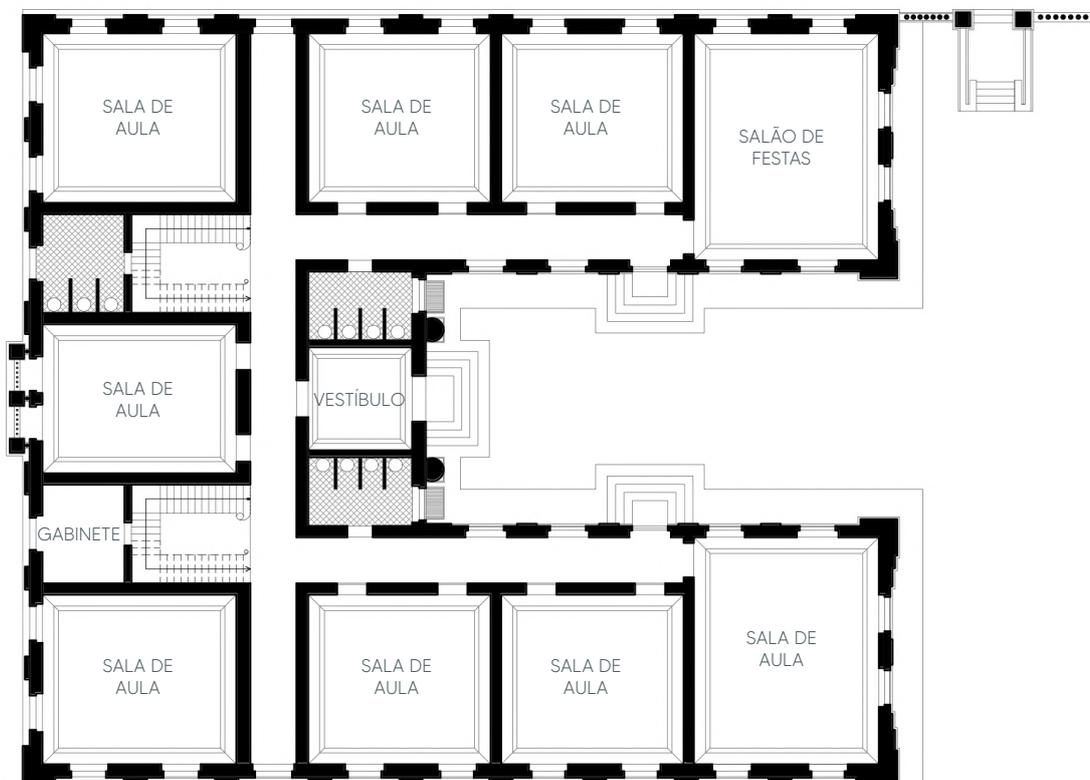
Redesenho da planta do pavimento térreo (planta da época da construção).
